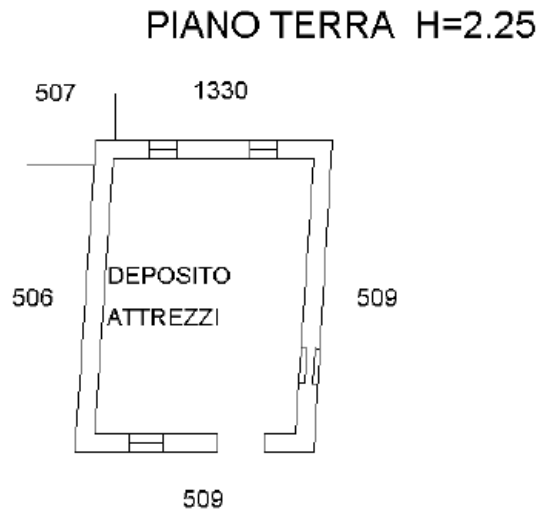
Estratto della planimetria catastale – p.lla 1949 p.t.
